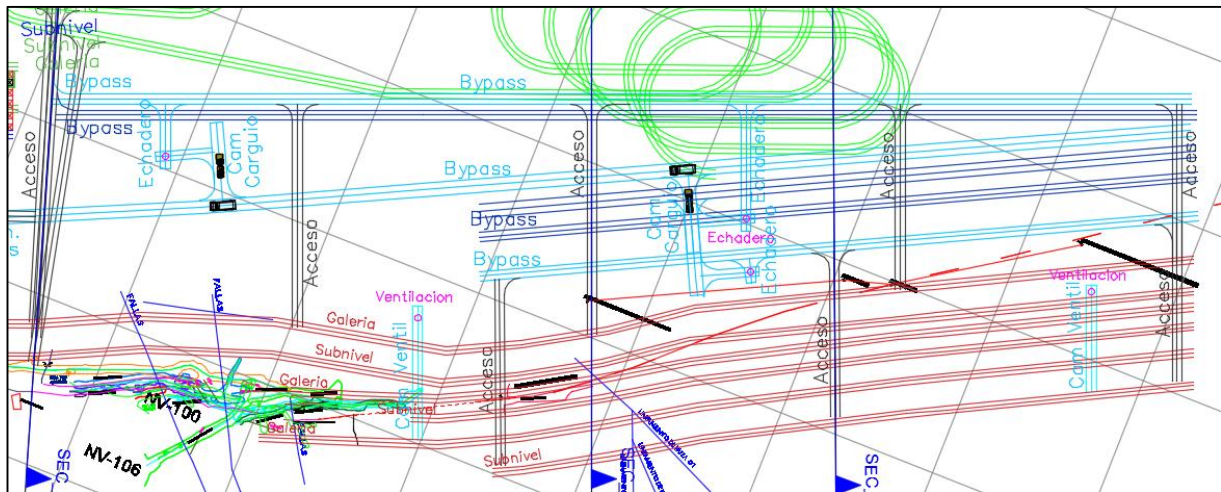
Vista en Planta del Diseño estándar de preparación para tajeo Sub Level Stopping
